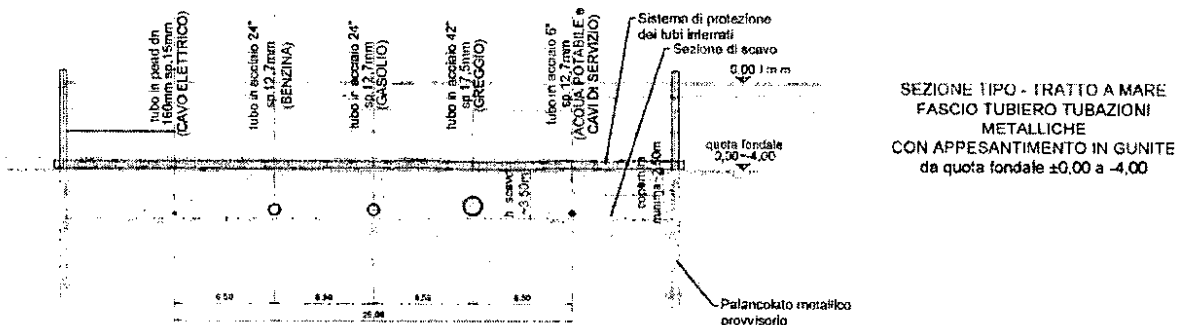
Fascio tubiero - tratto a mare: sezione di posa fino da quota fondale 0.00 a -4.00 m slmm. Fonte SIA
